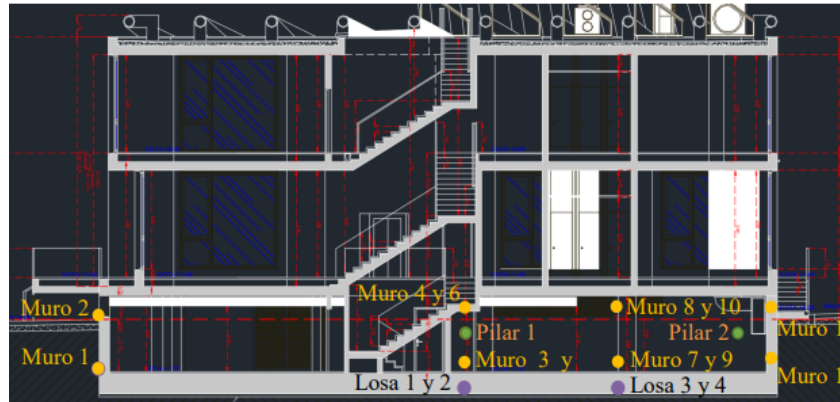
Detalle en alzado de zonas monitorizadas en el aparcamiento.
